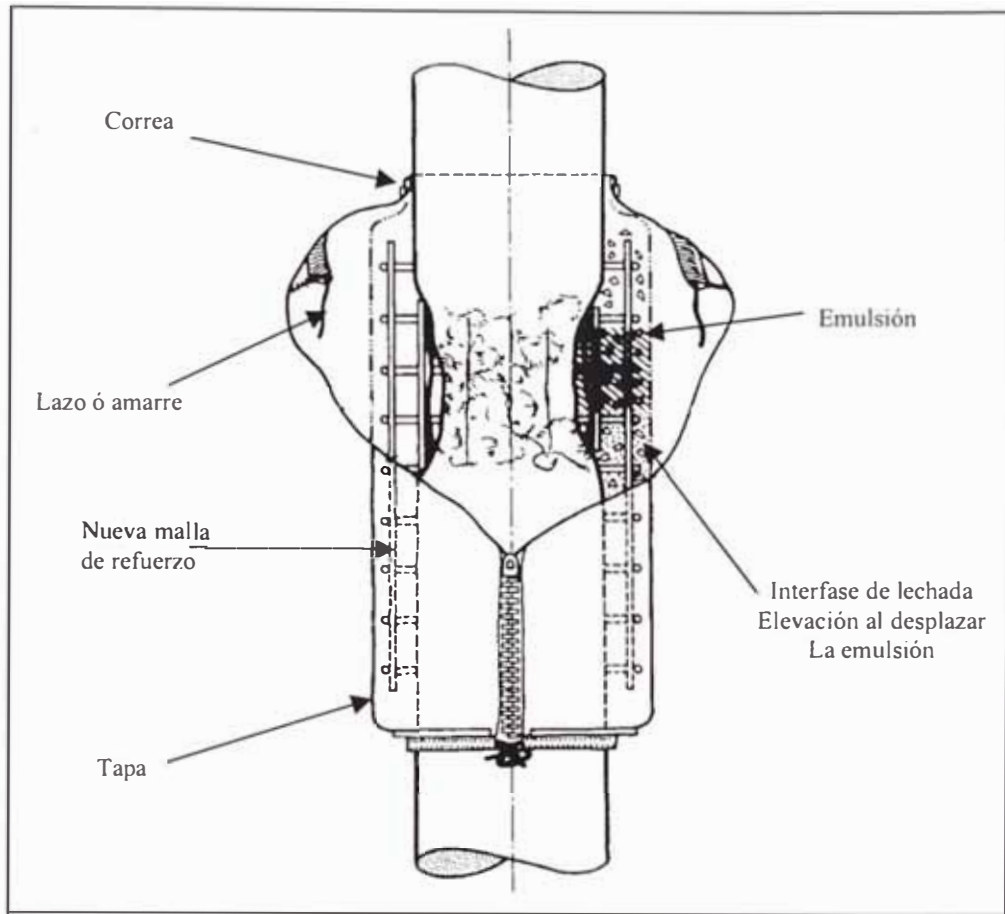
Detalles de una reparación que usa encofrado flexible.
